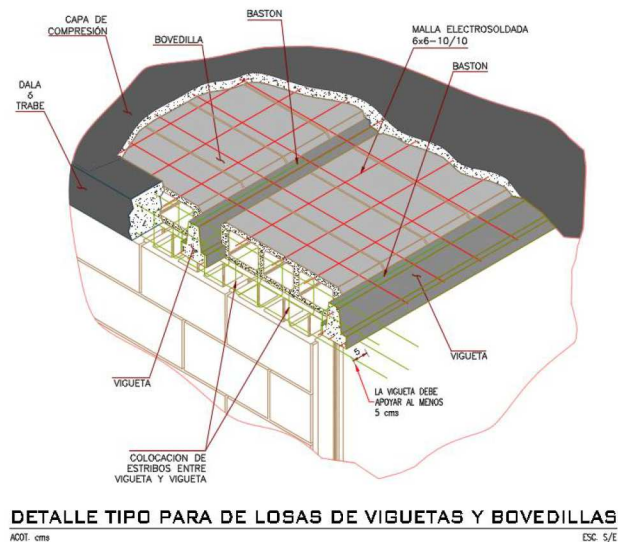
Detalle estructural de losa de vigueta y bovedilla.
